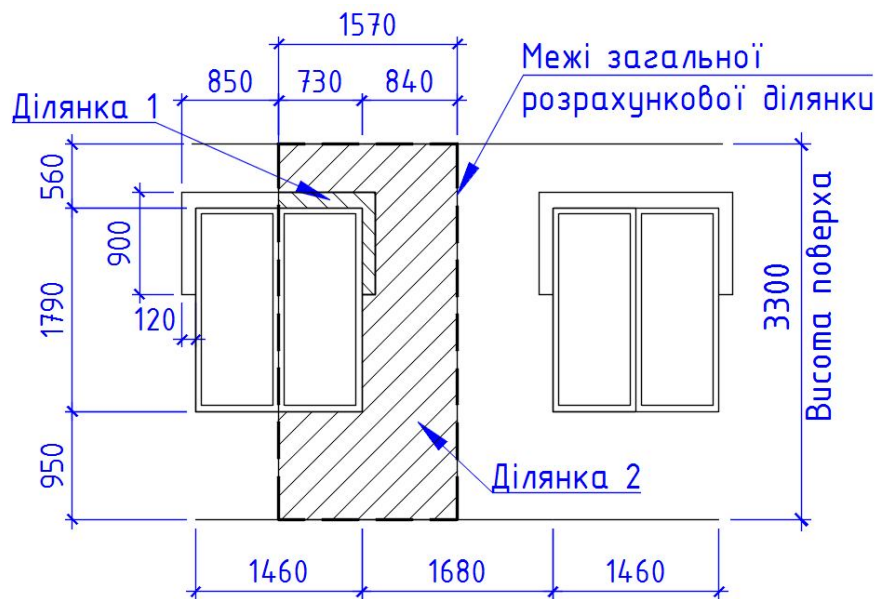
Фрагмент фасаду з розрахунковою ділянкою
